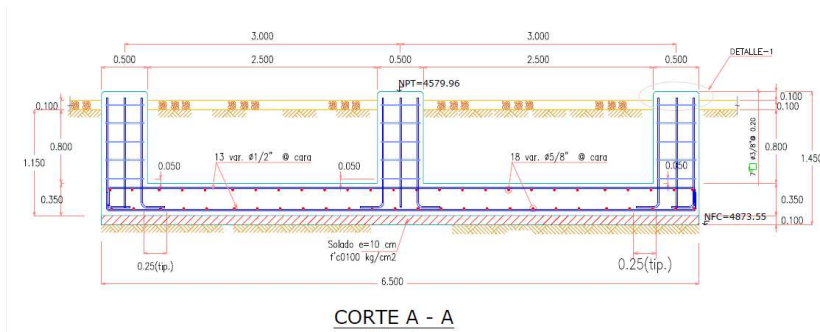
Detalle de sección A-A de cimentación para Seccionador de barra
